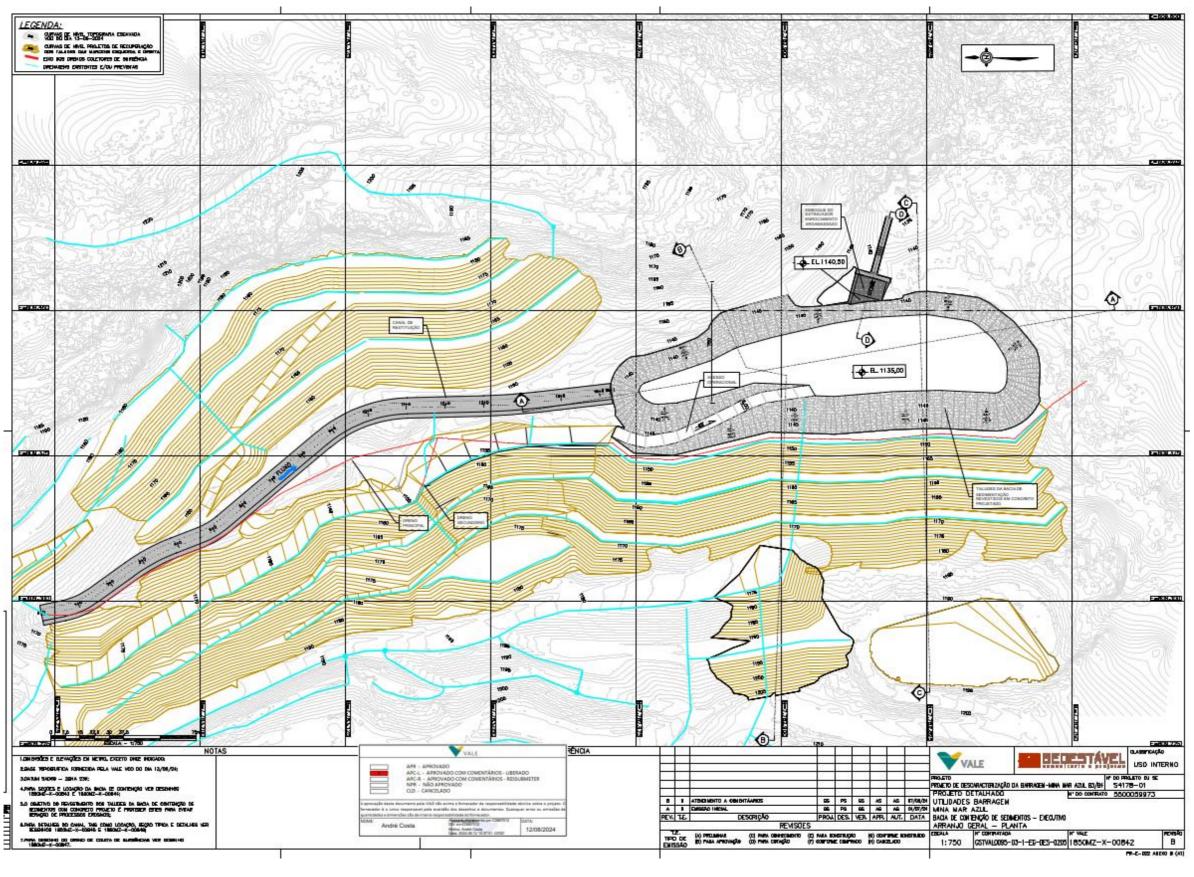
Barragem B3B4 - Conformação Final - Arranjo Bacia de Contenção de Sedimentos e Canal Central - Executivo.
